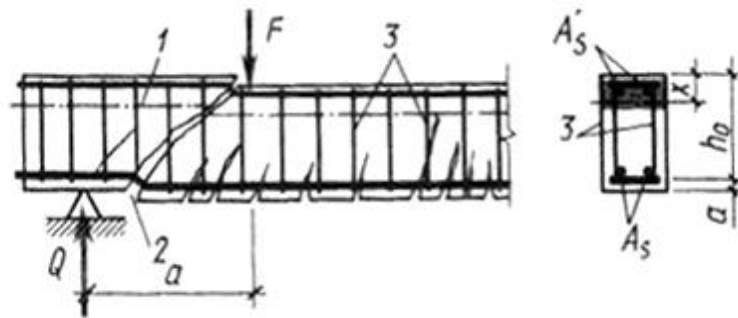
Схема руйнування вигнутого елемента по похилому перерізу від переважаючої дії поперечної сили: 1 – нульова лінія, 2 – похила тріщина, 3 – хомути
